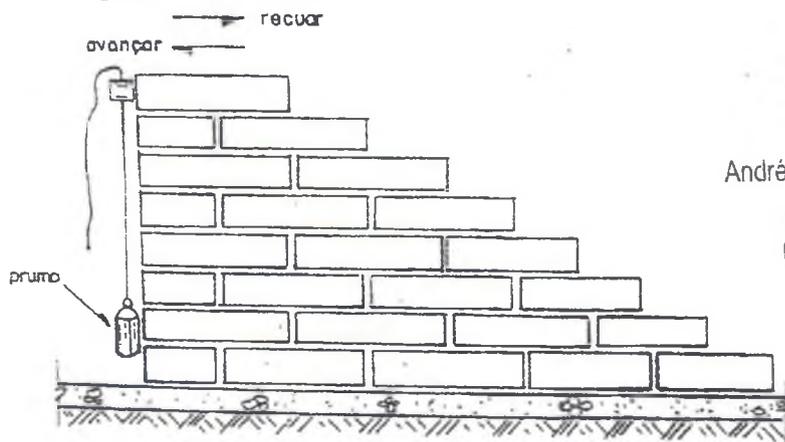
Detalhe do nivelamento da elevação da alvenaria.
